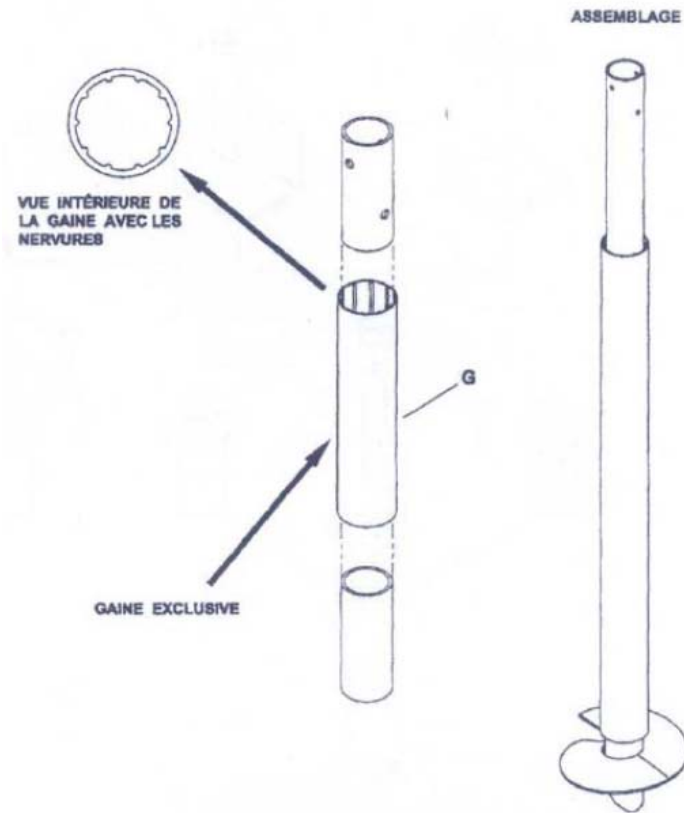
Assemblage des éléments constituant les TECHNO PIEUX®
